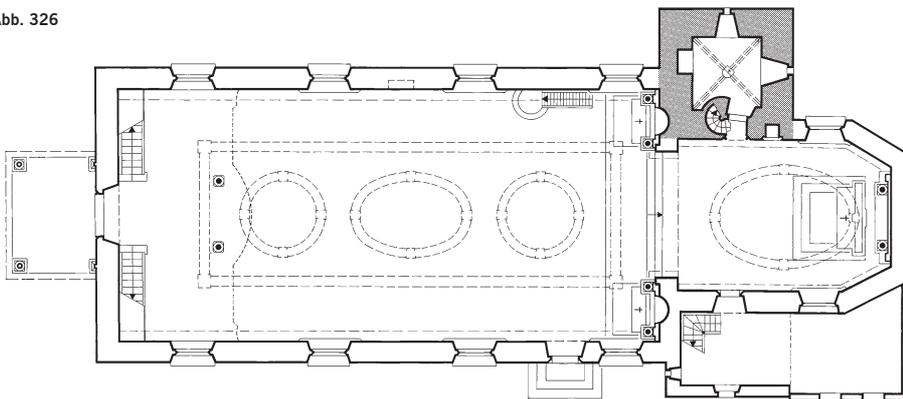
Neuheim, Pfarrkirche St. Maria. Grundriss 1:300.
